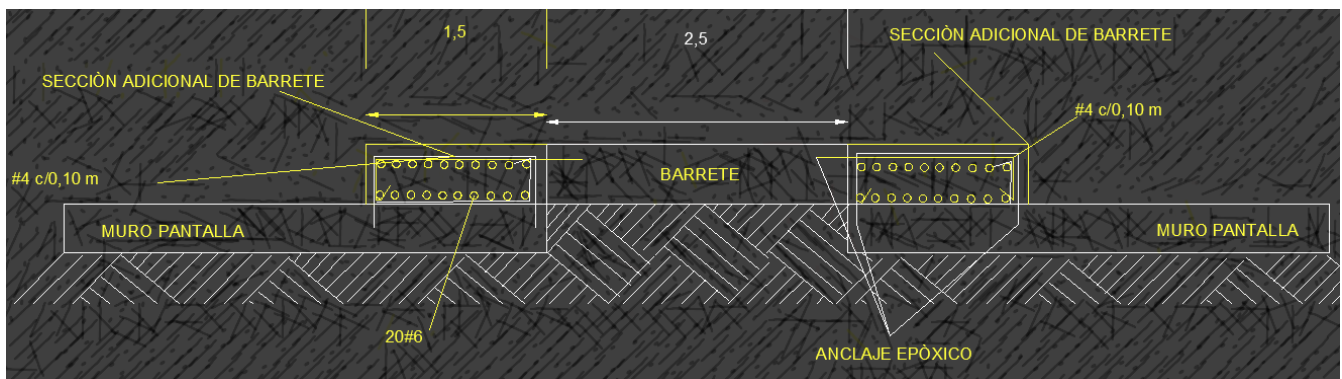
Planta detalle reparación de barrete. Fuente: Propia
